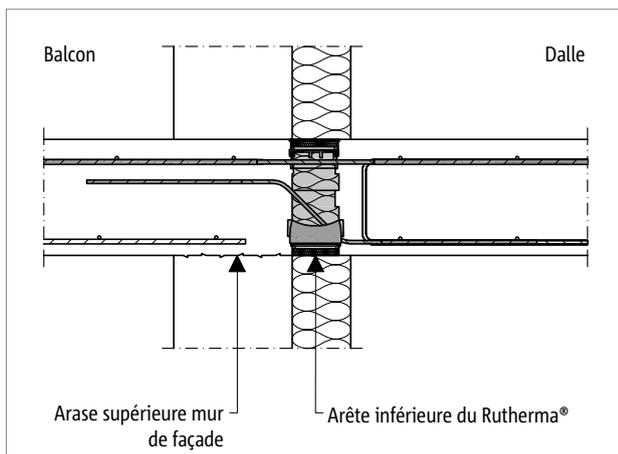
Schöck Rutherma® T type DBi : balcon en béton coulé sur place avec dalle en béton coulé sur place sur mur en béton armé
